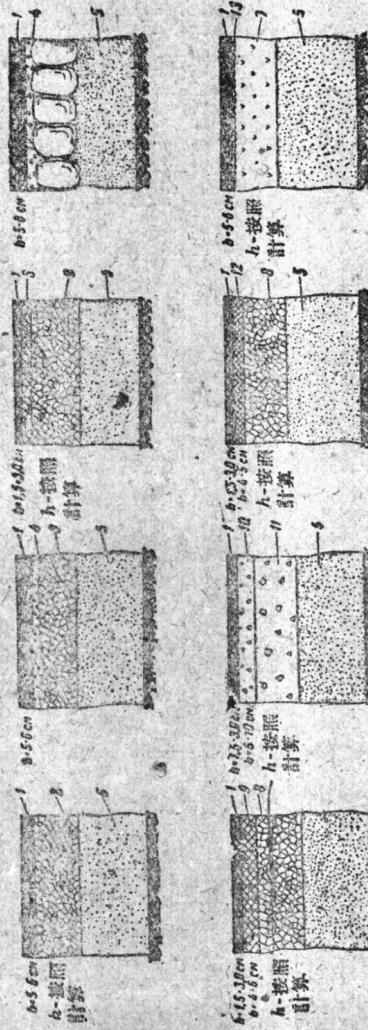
采用冷地沥青混凝土和含柏油混凝土的道路结构示例：
